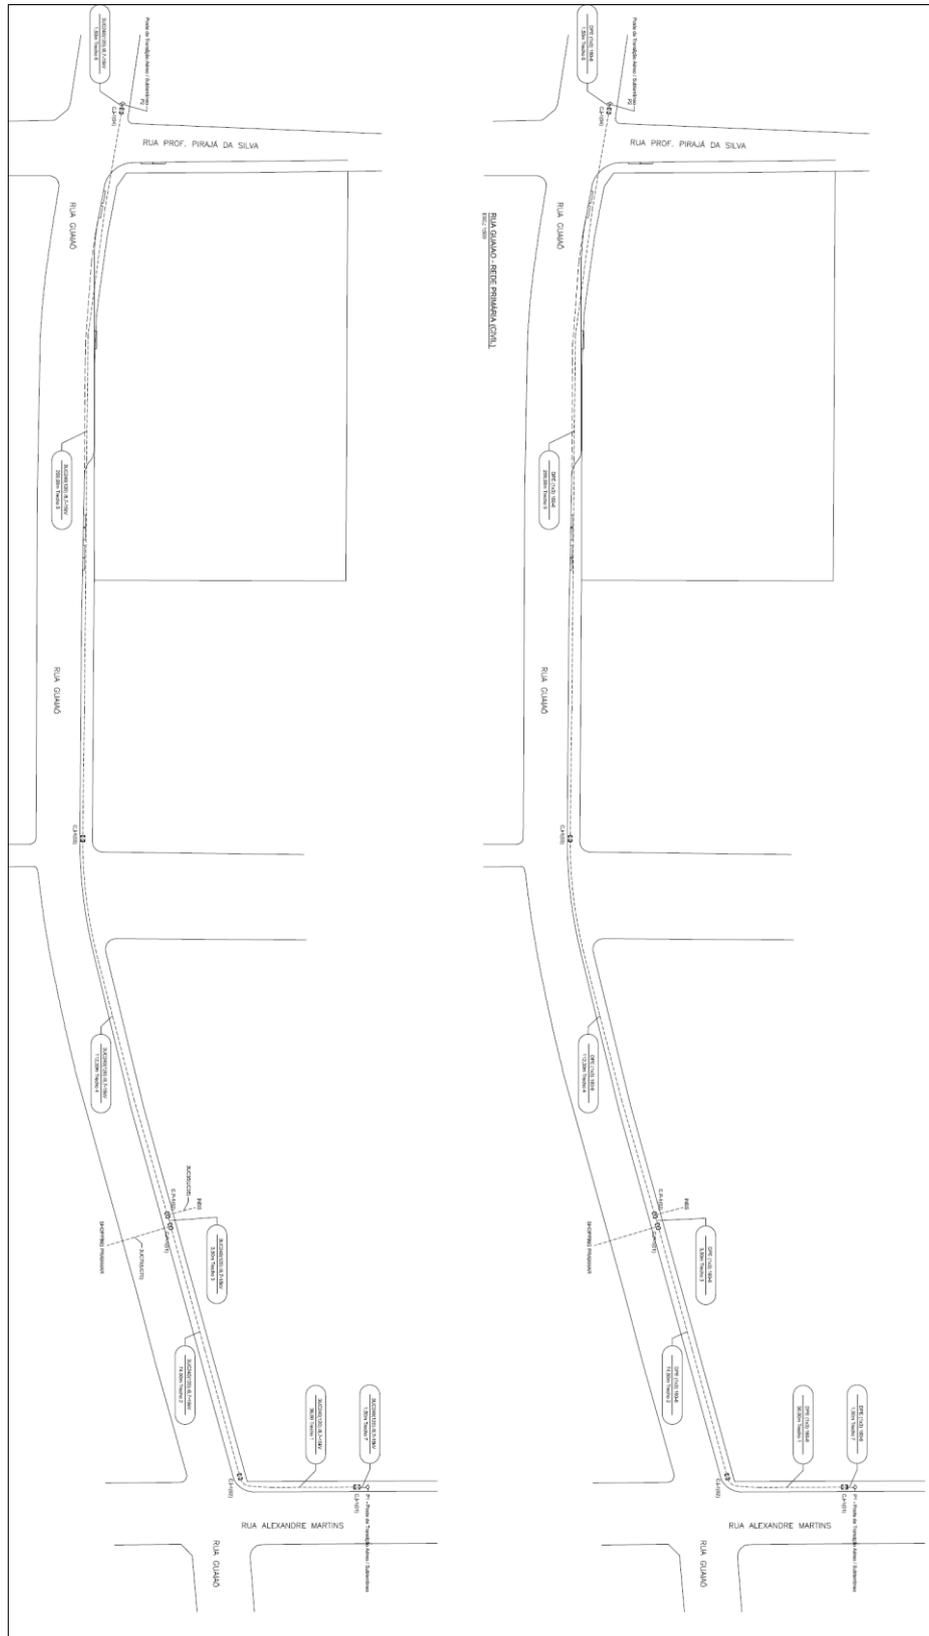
Projeto Rede elétrica subterrânea – Iluminação pública
